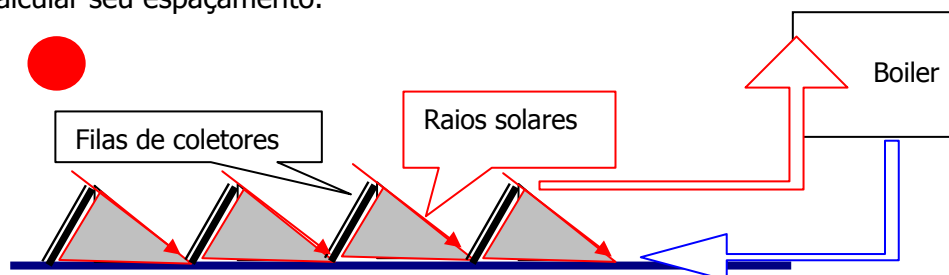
croquis de espaçamento entre linhas de coletores colocados sobre laje plana
